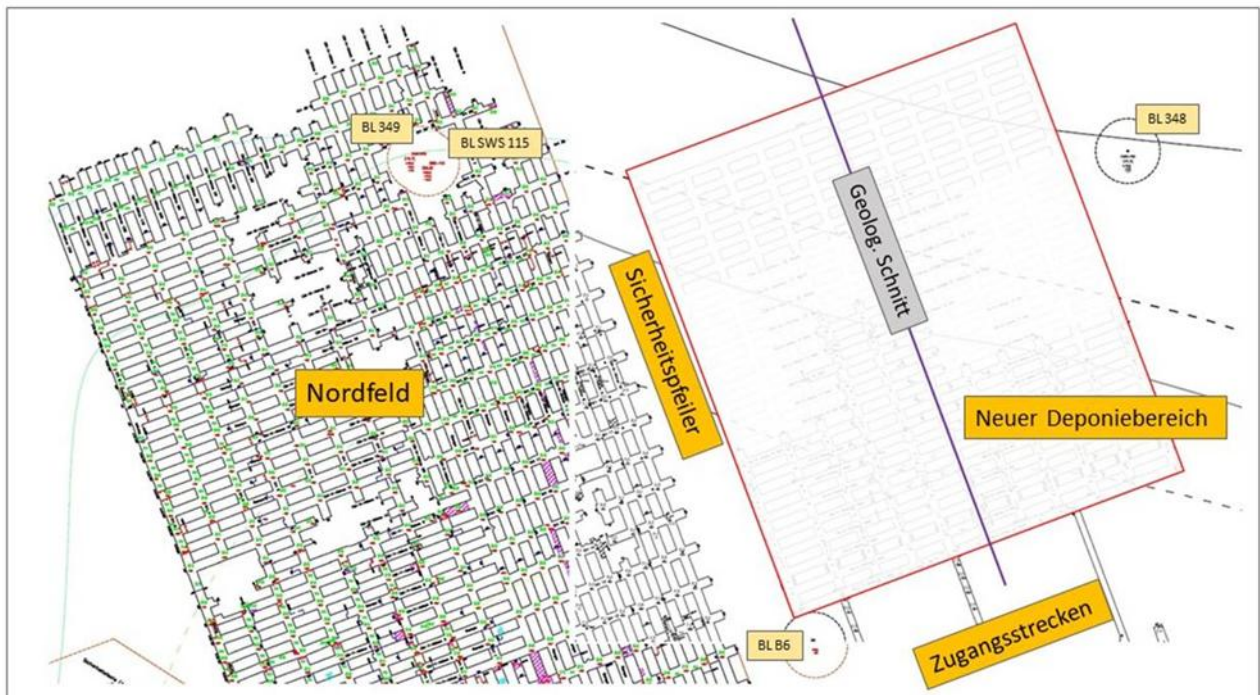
Lageplan und Grundriss des neuen Deponiebereiches
